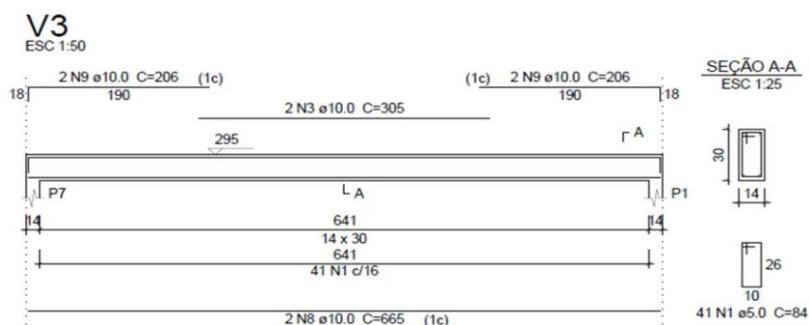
Seção das vigas de respaldo e detalhes da armadura long/trans
